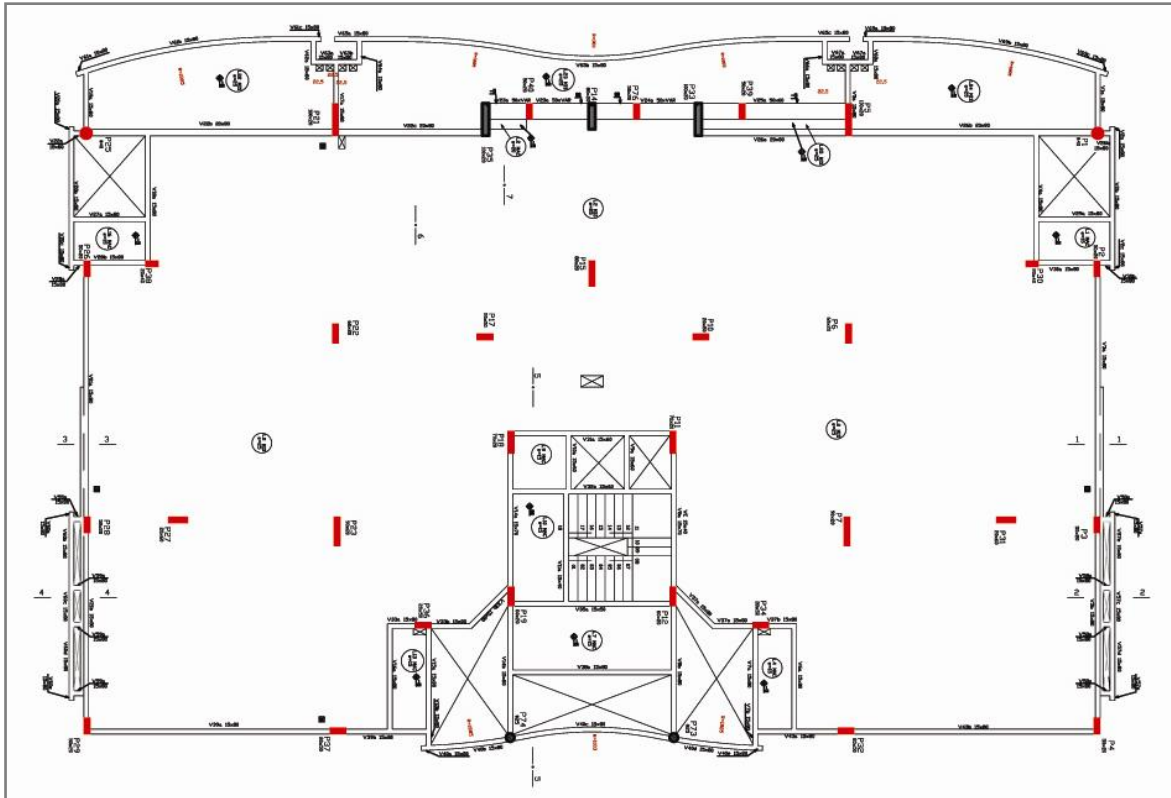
Planta de forma do projeto estrutural do pavimento tipo do bloco 02.
